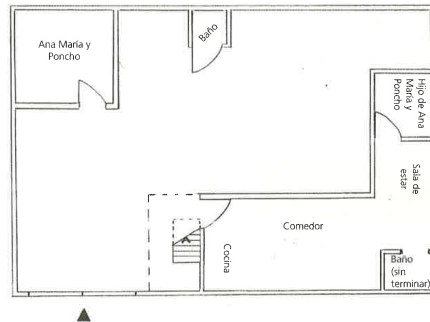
Después: planta baja de la casa familiar de los Hernández con escaleras exteriores
